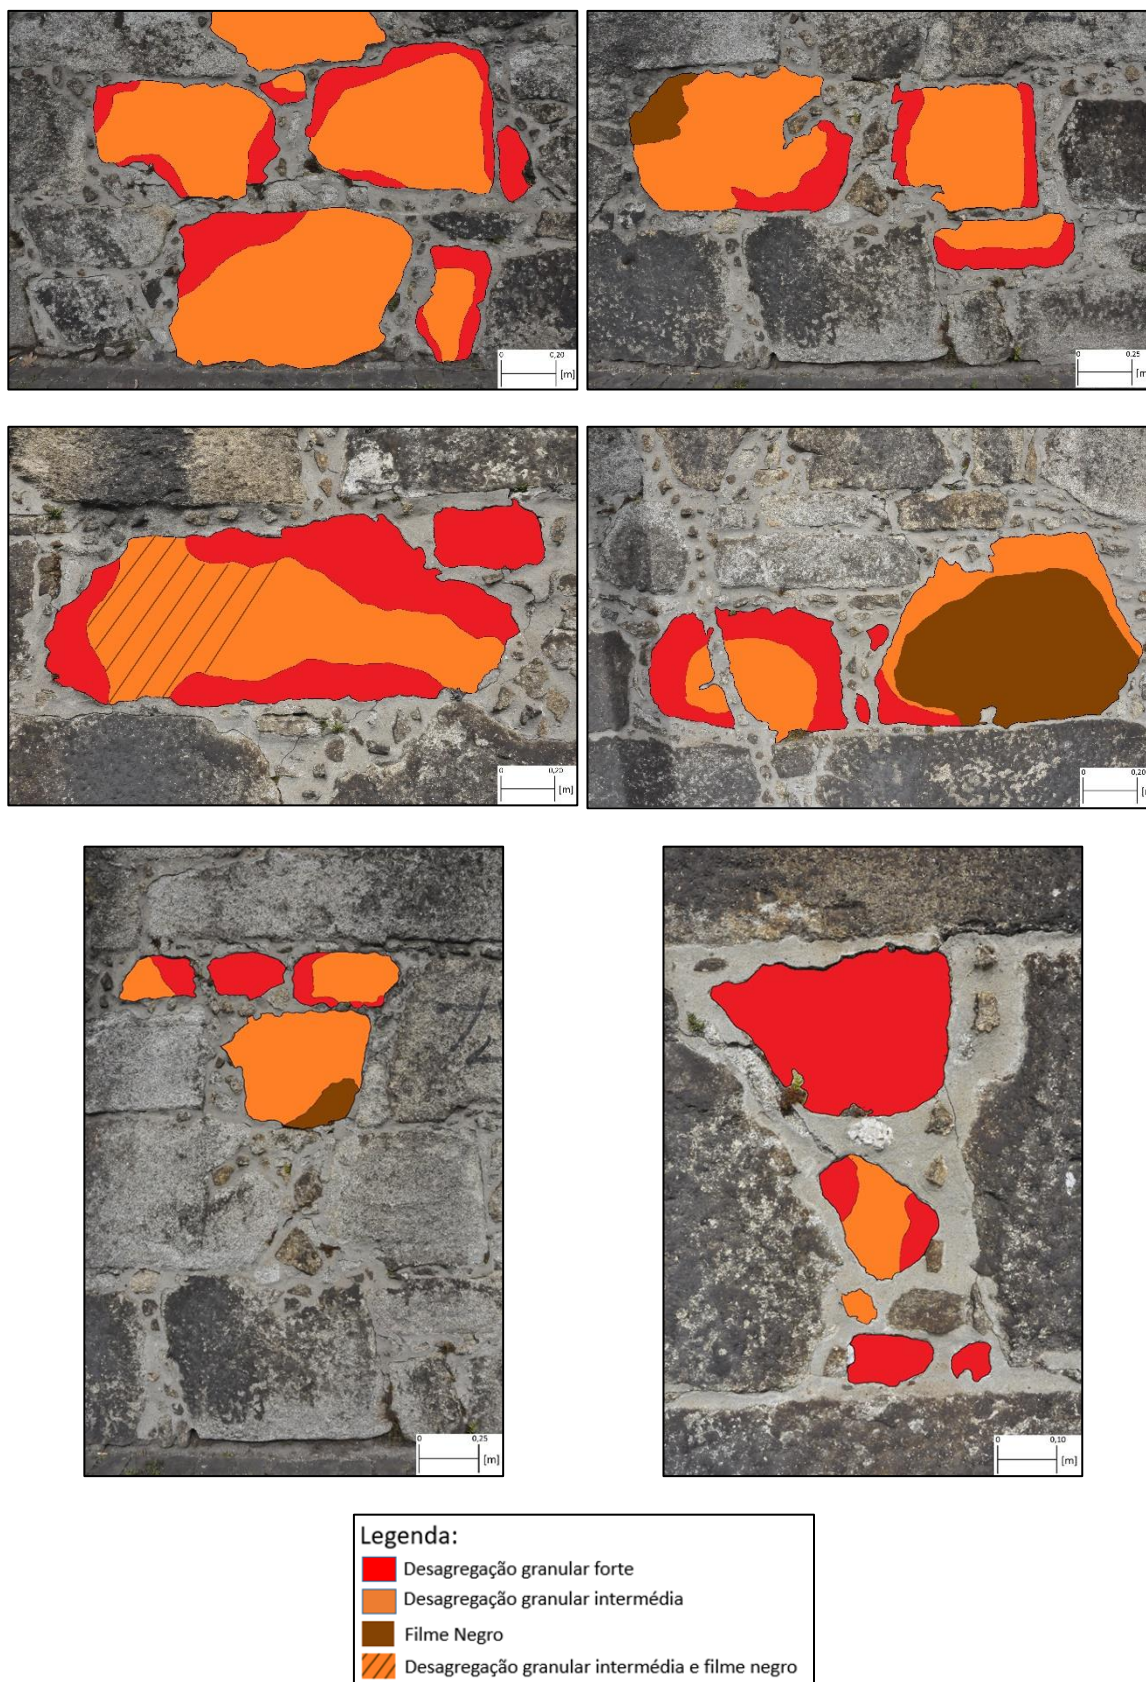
Cartografias das deteriorações em setores do muro de suporte da fachada Sul do Hospital de Santo António
